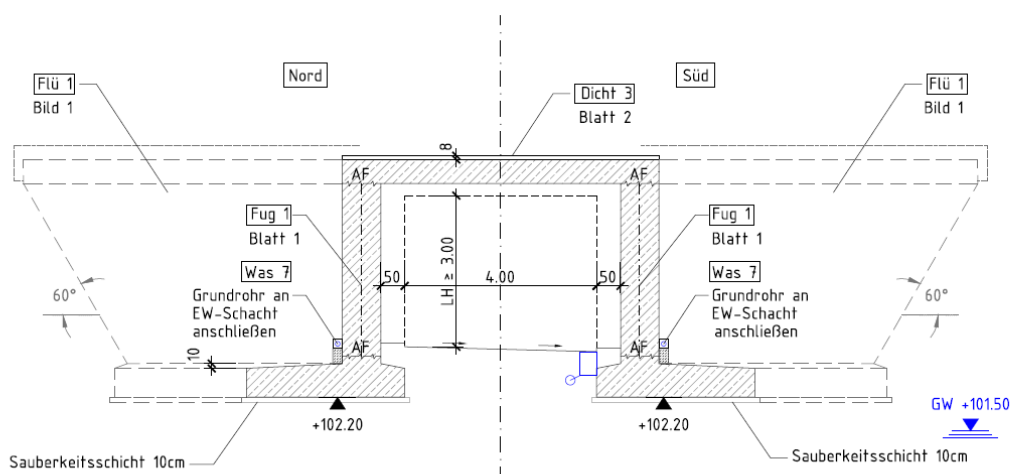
Querschnitt Bauwerksplan, Unterführung Machbarkeitsstudie (Büro BUNG 2023)
